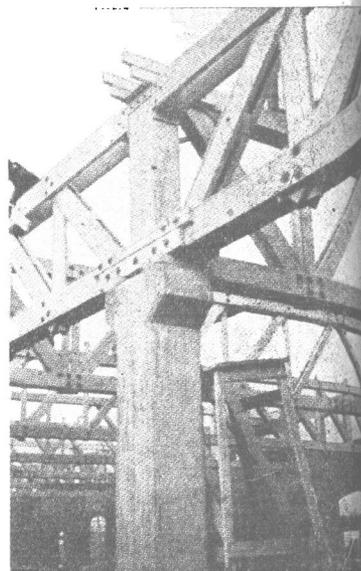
Detalle de las armazones de madera en una de las columnas de hormigón. El armazón transversal para la sección del centro apoyará en el punto donde trabaja el operario.
